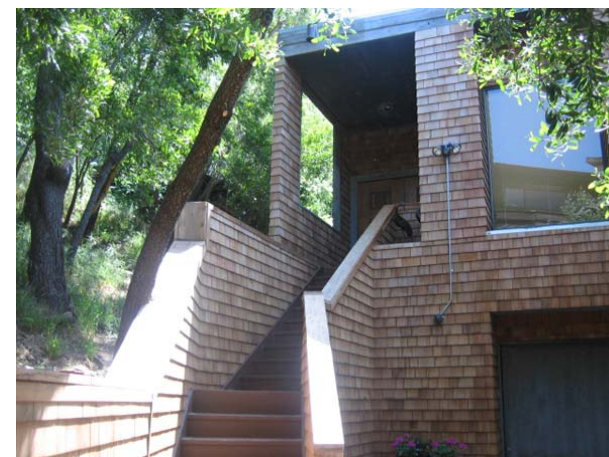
Telha de madeira tipo *shingle* em forro exterior como *siding* (bestroofingca.com)
